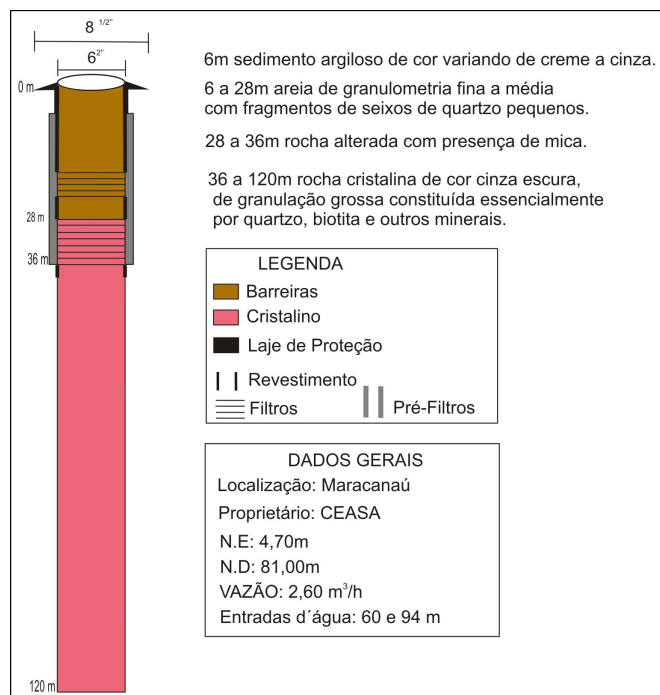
Poço P-78 captando o Sistema Misto. (Fonte: SOHIDRA-2008)
